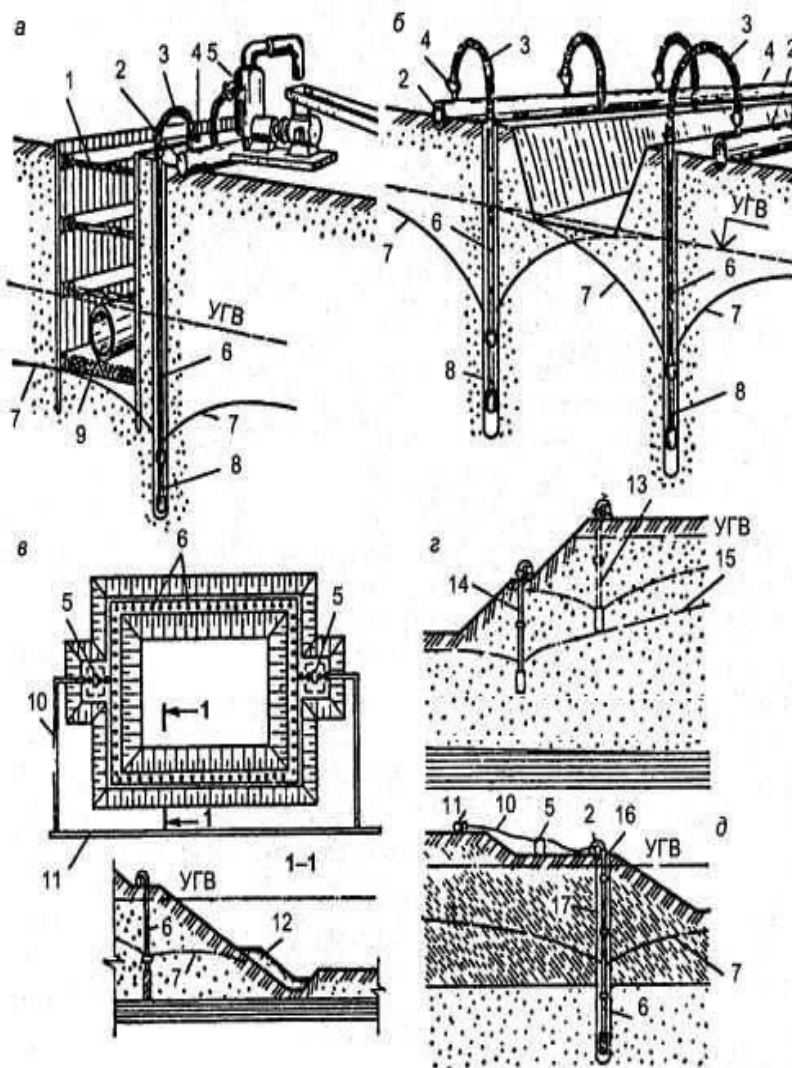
Водопонижение легкими игольчатыми установками: а – однорядные установки; б – двухрядные установки; в – замкнутые установки; г – двухъярусные установки; д – заглубление игольчатого фильтра; 1 - траншея с креплениями; 2 - всасывающий коллектор; 3 - соединительные патрубки (шланги); 4 - кран или вентиль; 5 - насосный агрегат; 6 - игольчатые фильтры; 7 - пониженный уровень грунтовых вод; 8 - водоприемное фильтровое звено игольчатого фильтра; 9 - проложенный трубопровод в траншее; 10 - напорный трубопровод; 11 - сборный трубопровод; 12 - дренажная пригрузка; 13 - игольчатые фильтры верхнего яруса; 14 - то же, нижнего яруса; 15 - конечное положение депрессионной поверхности грунтовых вод; 16 - глиняный тампон; 17 - песчано-гравийная обсыпка.
